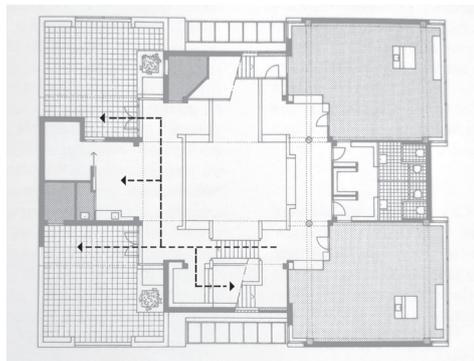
Erschliessungsnetz innerhalb der Apollo Grundschule: Klassenzimmer und Halbggeschoss mit Dachterrassen.
